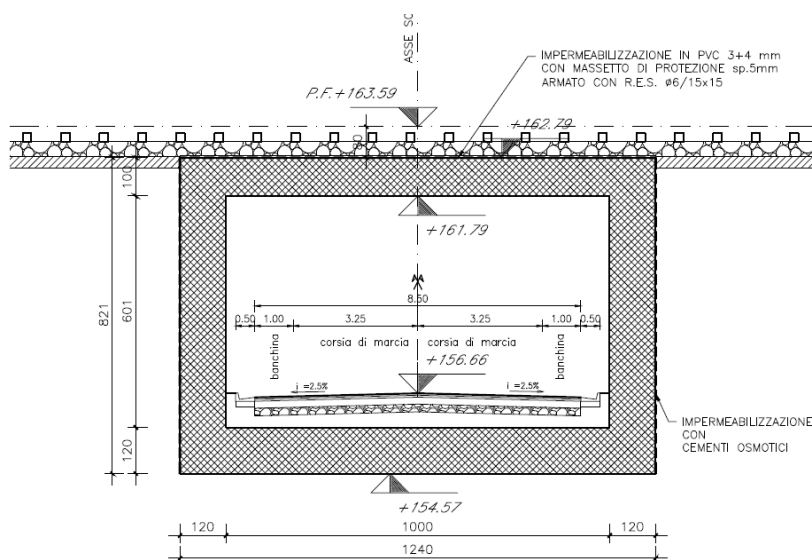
SEZIONE TRASVERSALE SOTTOVIA SL03
